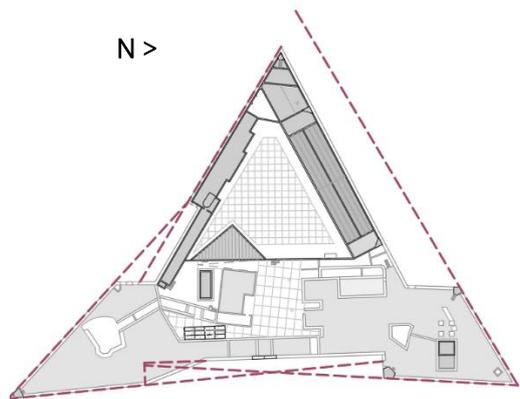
Planta de cubierta del Castillo de San Francisco. Elaboración propia.
